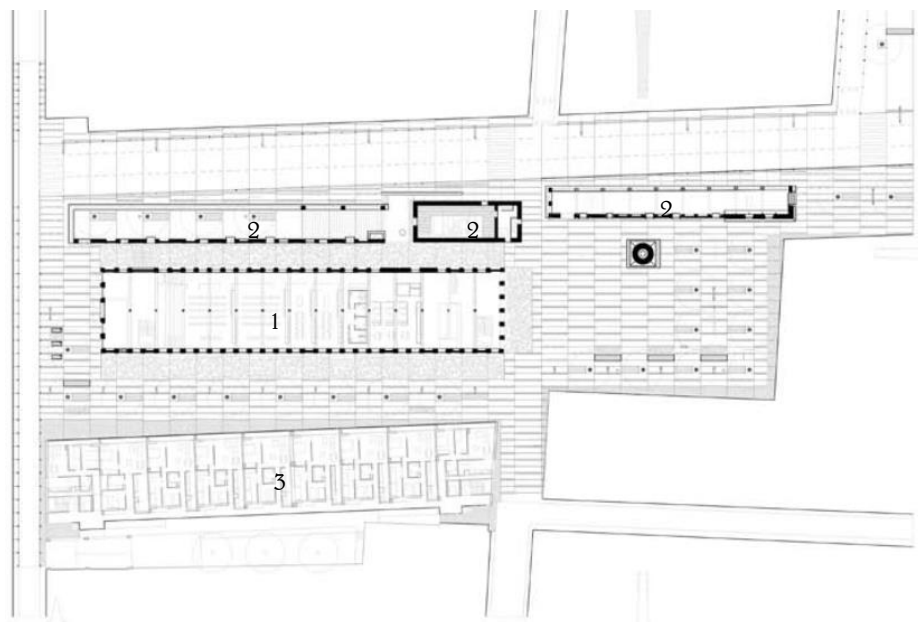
Plano planta de la plaza Can Ribas - España.
